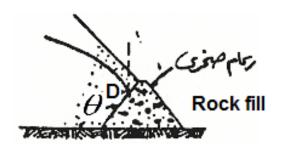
بداية خط الرشح في حالة عدم وجود قطاع من المواد الخشنة
